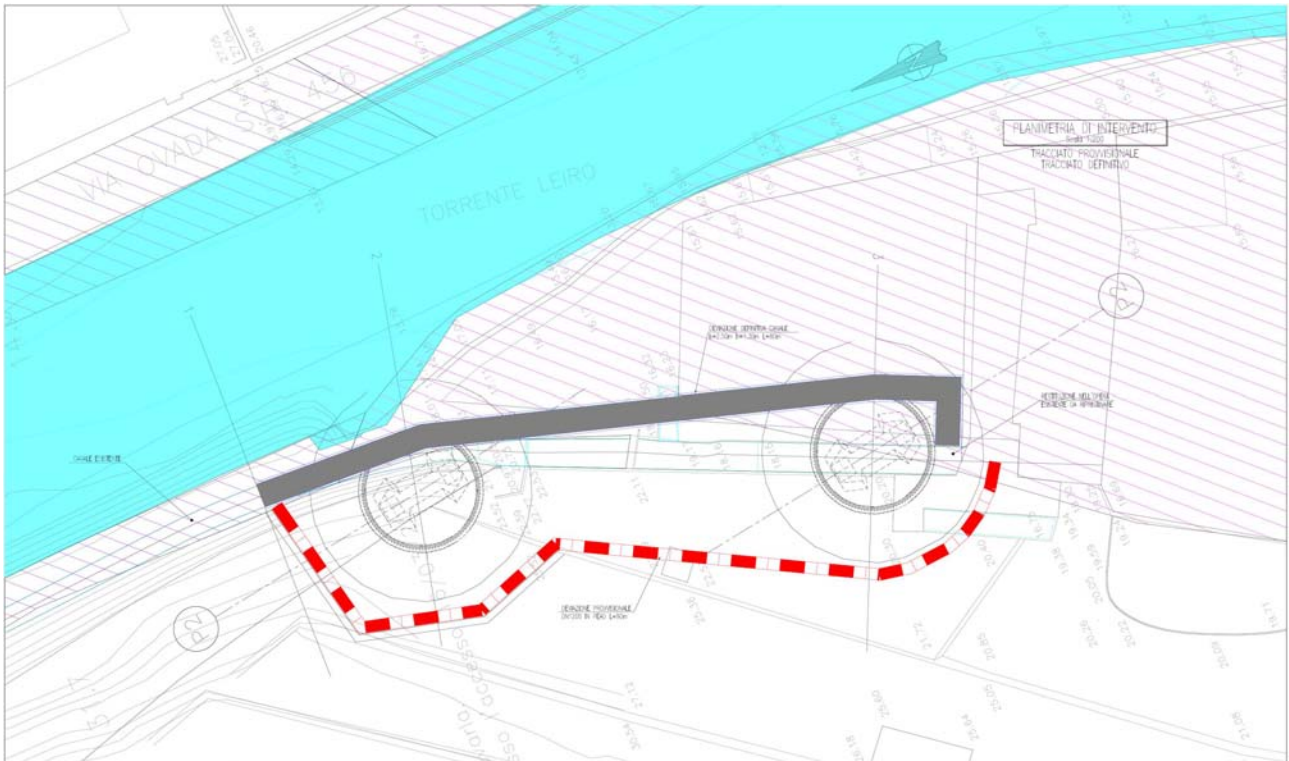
Variante progettuale – sistemazione idraulica, deviazione canale artificiale
